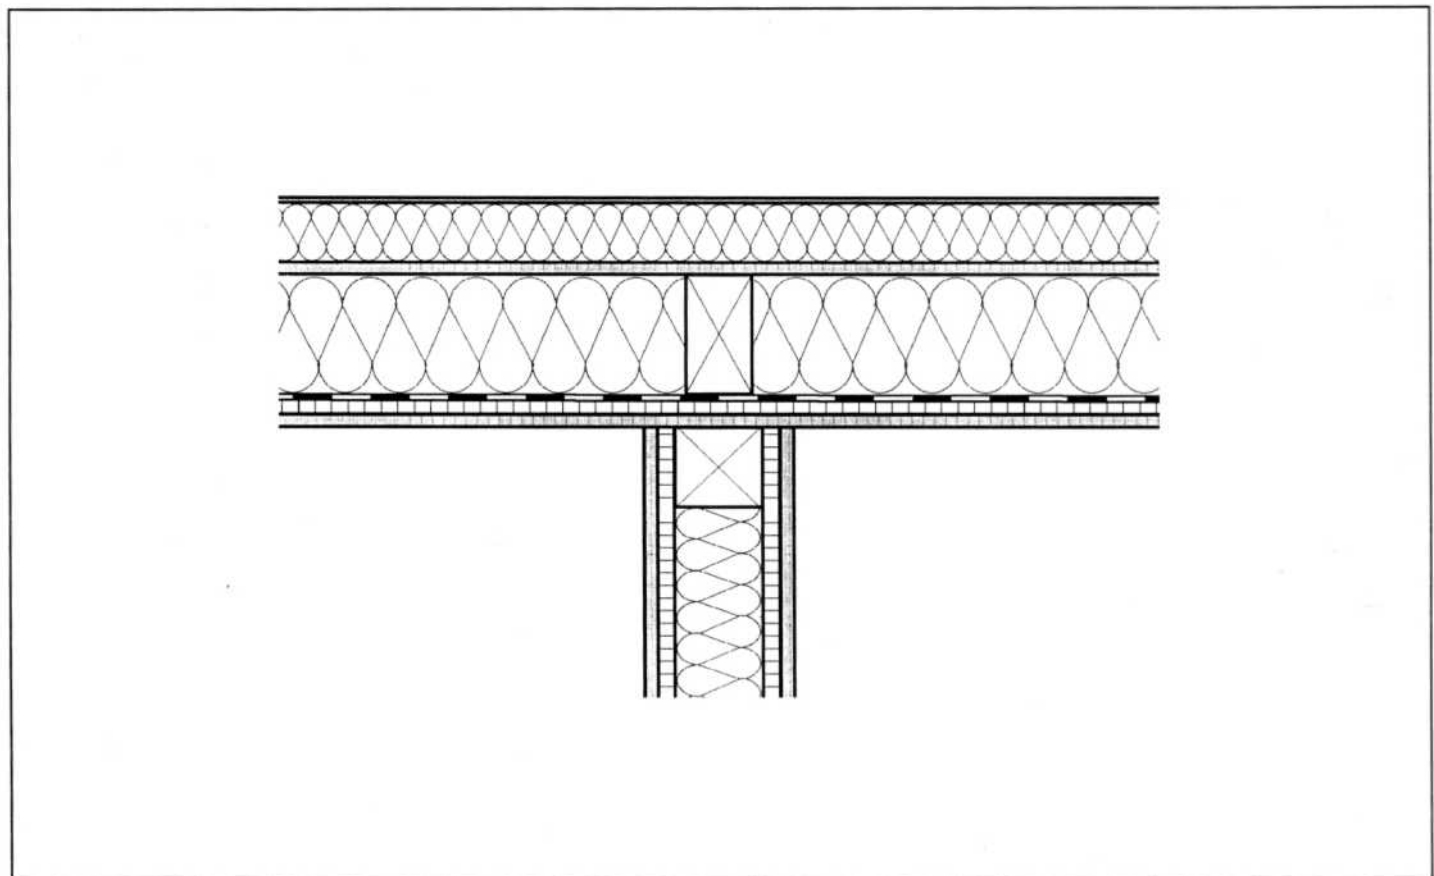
Geschoßdeckenanschluß mit Balkenträger für die Außenwand W 2 und die Geschoßdecke G 1.
